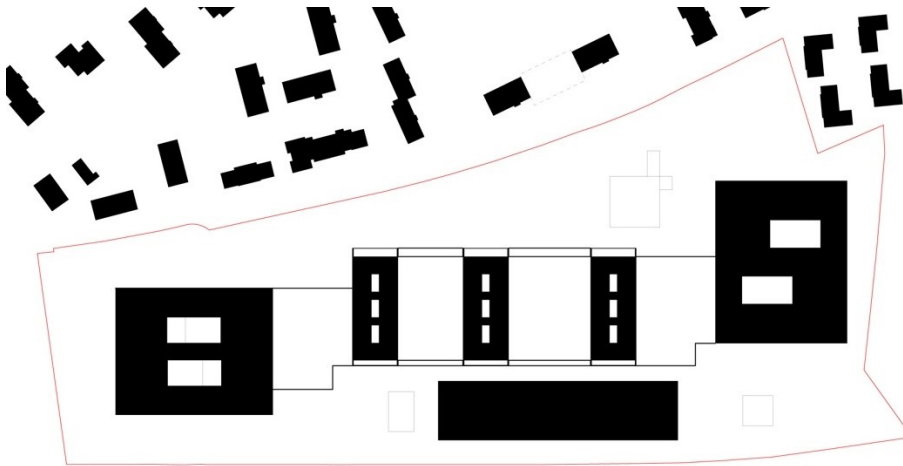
Schwarzplan mit Bebauungsplanperimeter in rot und den Bauten gemäss Richtprojekt.
